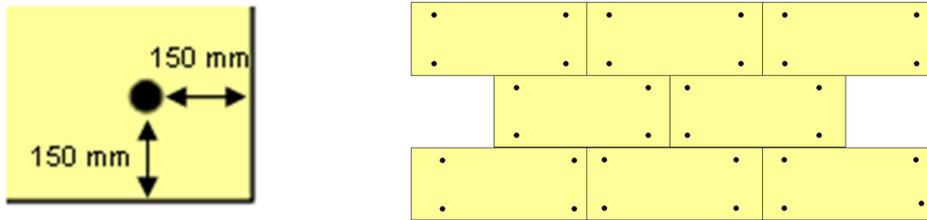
Esquema de colocación de espigas en las aristas de la placa
